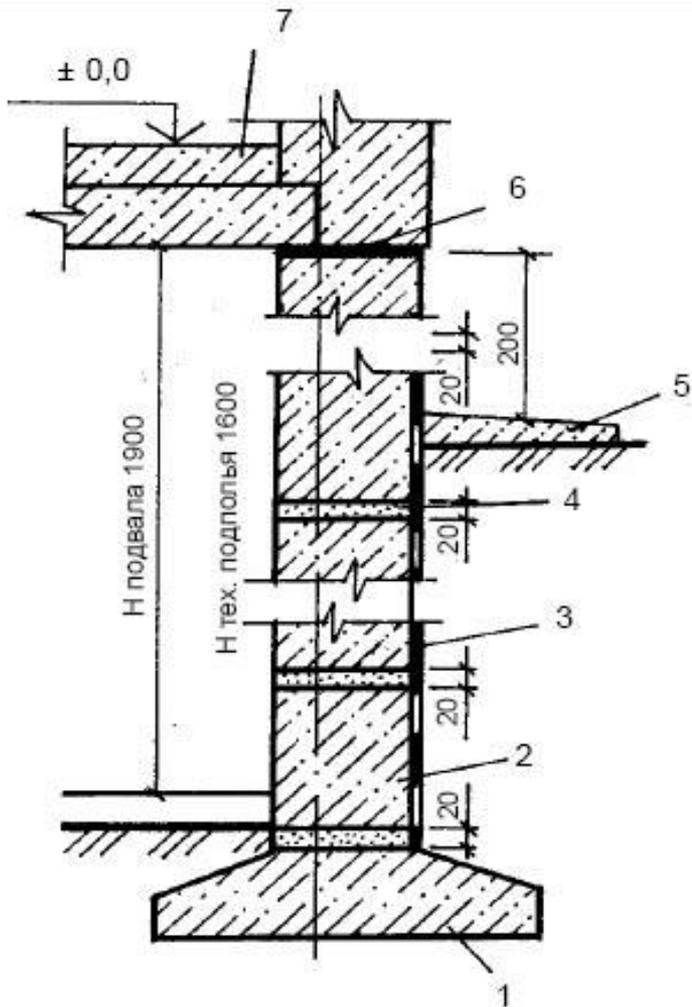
Сборный ленточный фундамент из бетонных блоков под стены дома с подвалом и техническим подпольем:
